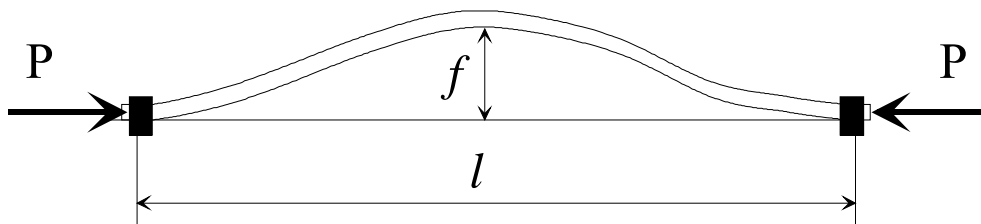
Flexion locale de la conduite entre deux ancrages
